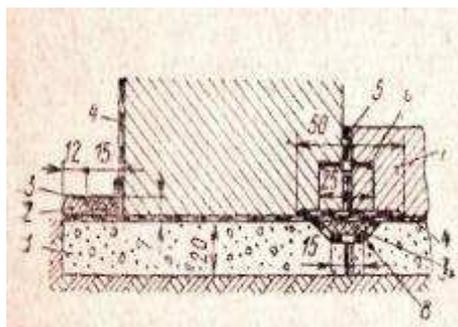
Сопряжения асфальтовой гидроизоляции основания сооружения со швами и гидроизоляцией стены (к п. 2.26)
